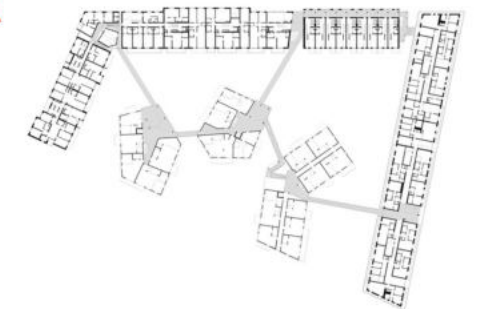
Grundriss Wohngeschoss Brückenebene (Vlay+Streeruwitz Architekten)
